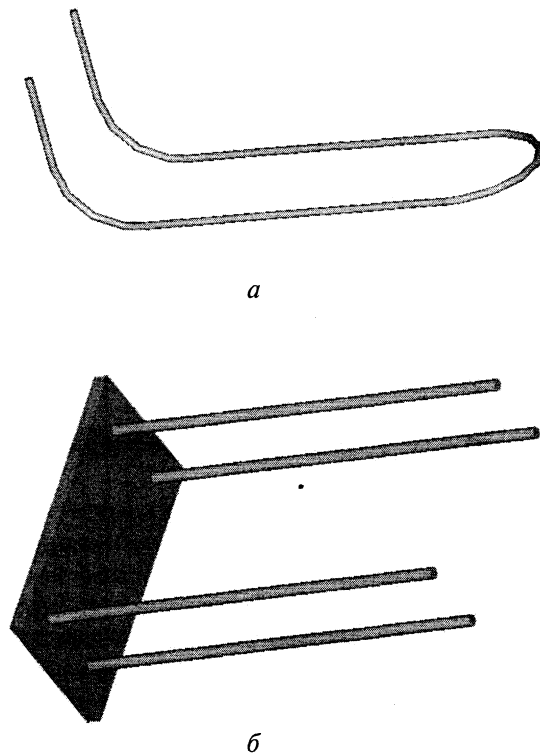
Типы закладных изделий: а — гнутые; б — сварные
